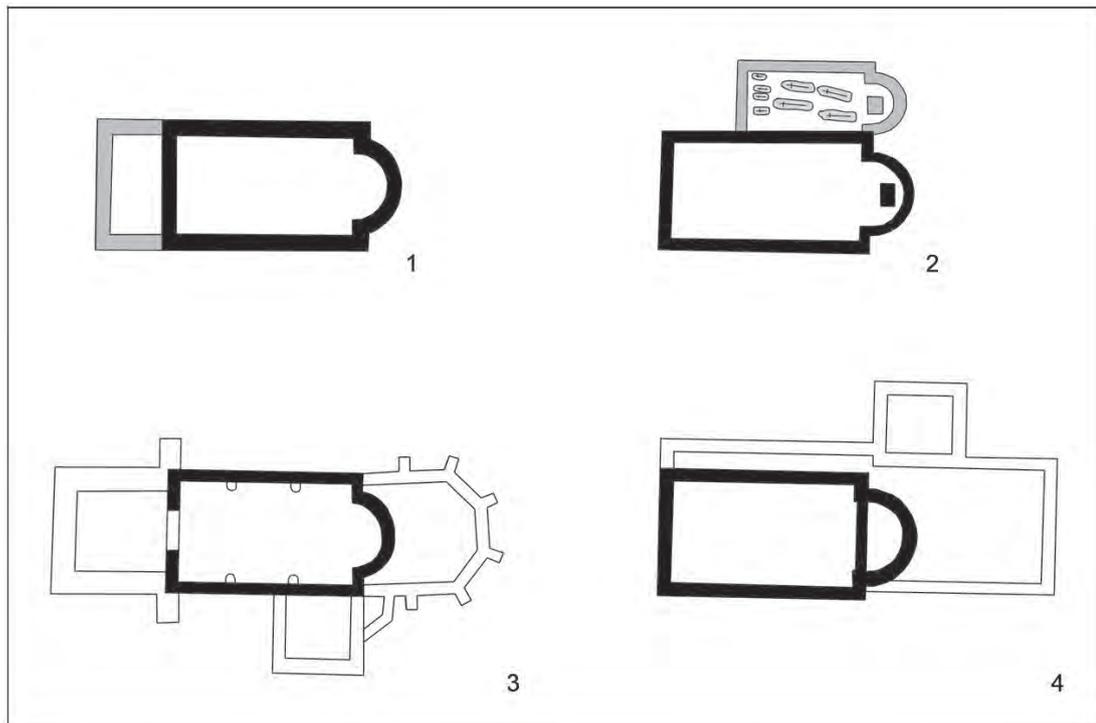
Karolingische Saalkirchen mit Apsis: 1 – Lauterhofen, 2 – Burg Sulzbach, 3 – Burg Oberammerthal, 4 – Gebenbach. Alle Grundrisse genordet. M. 1:400 (Plan R. Röhl, BLfD).
